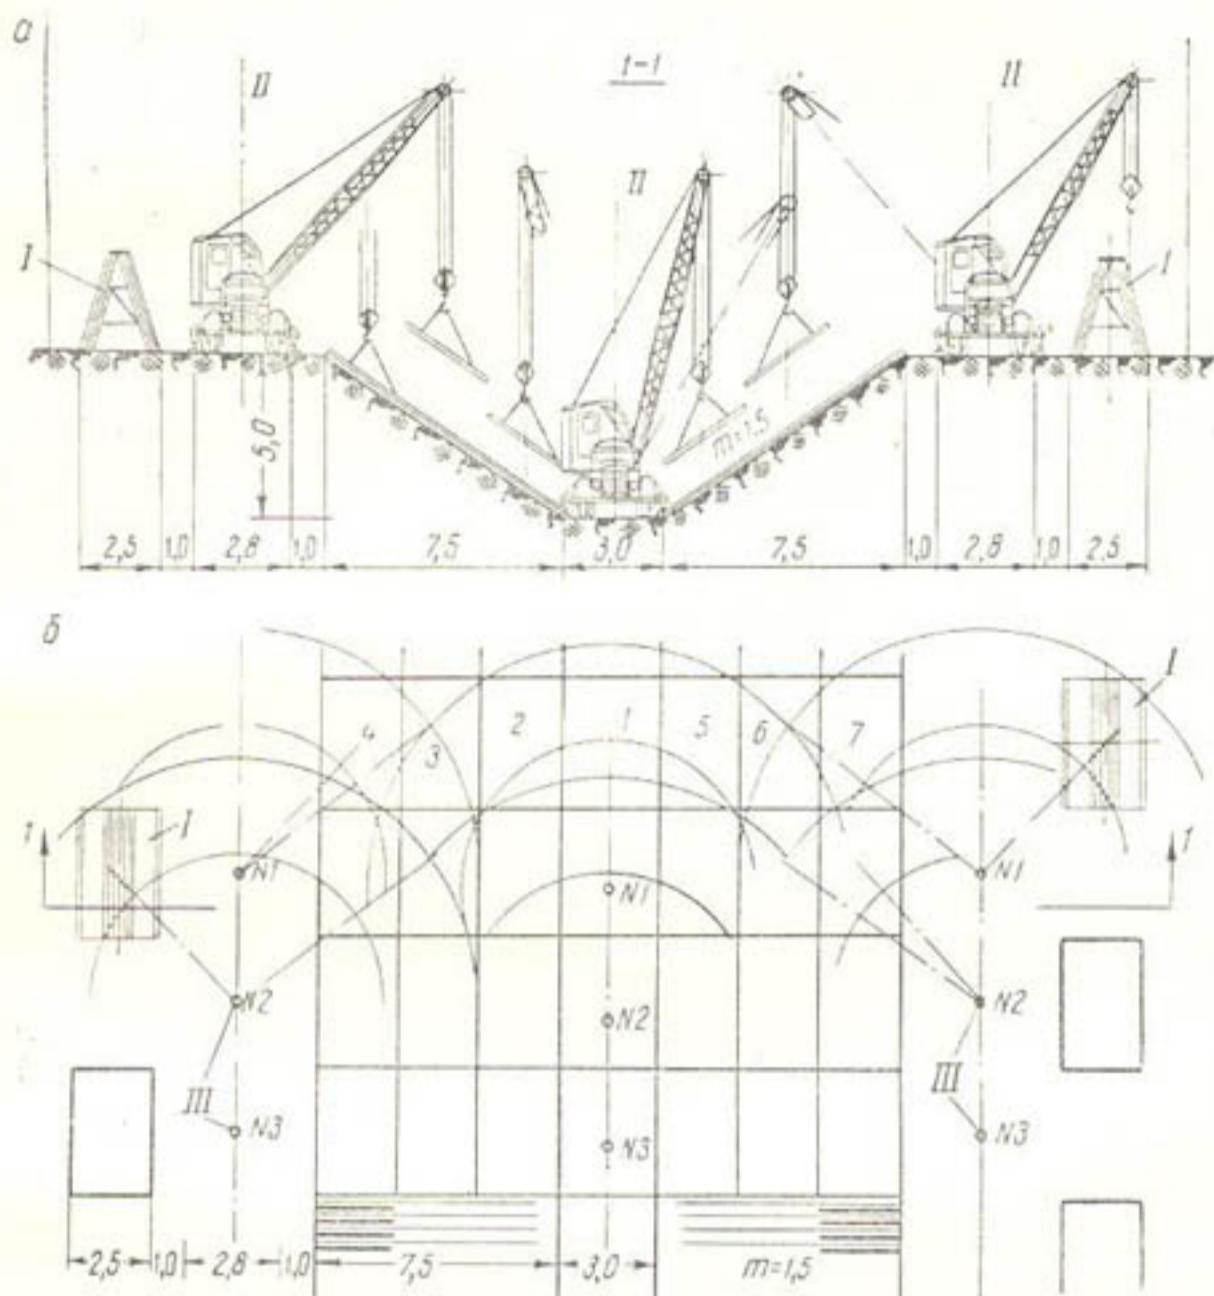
Схема монтажа плит размером 300×400 см кранами К-52 на канале глубиной 5 м:
